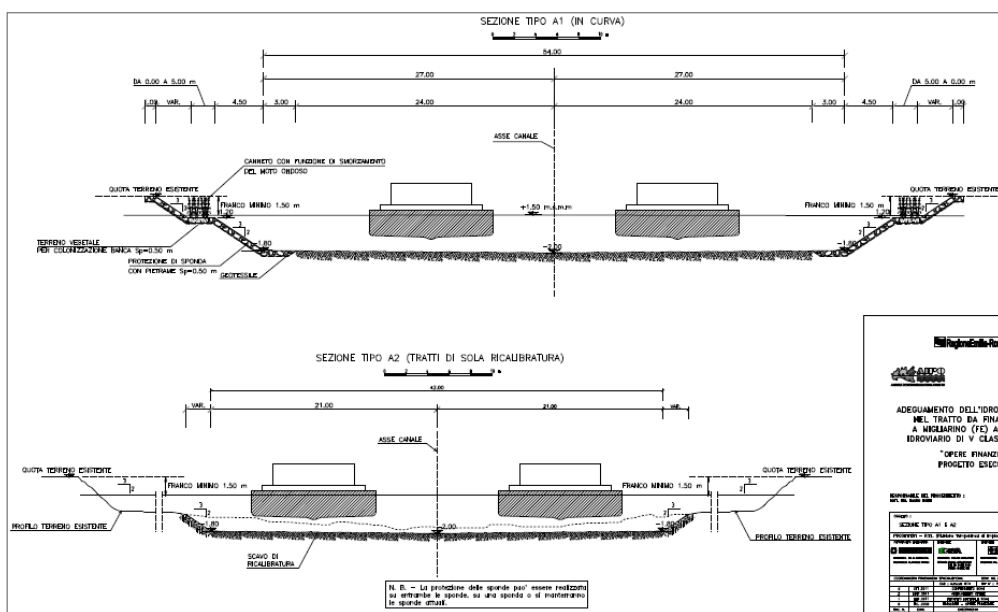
Sezione trasversale del tratto di adeguamento idroviario prevista nel PROGETTO PREGRESSO
